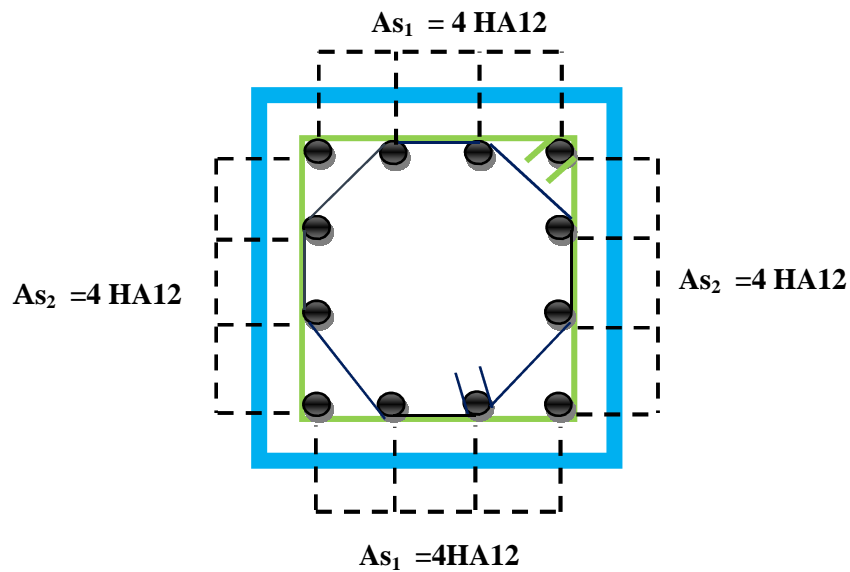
VI : Schéma ferrailage poteaux (40x40)
